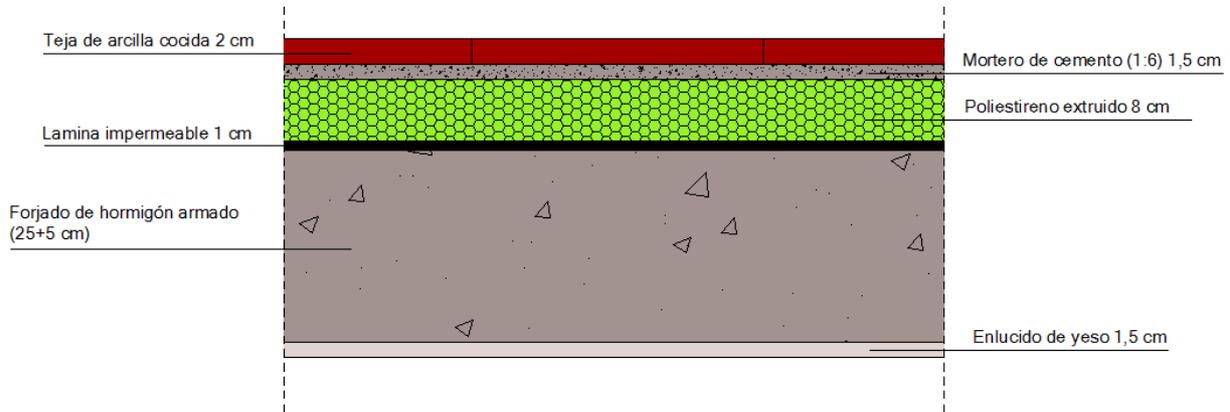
Detalle cubierta tipo 2 propuesta.2014.CAD.
